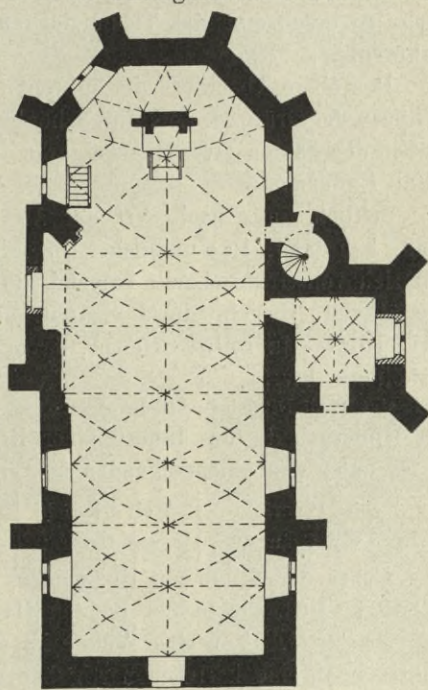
Seifersdorf, Grundriss der Kirche.
